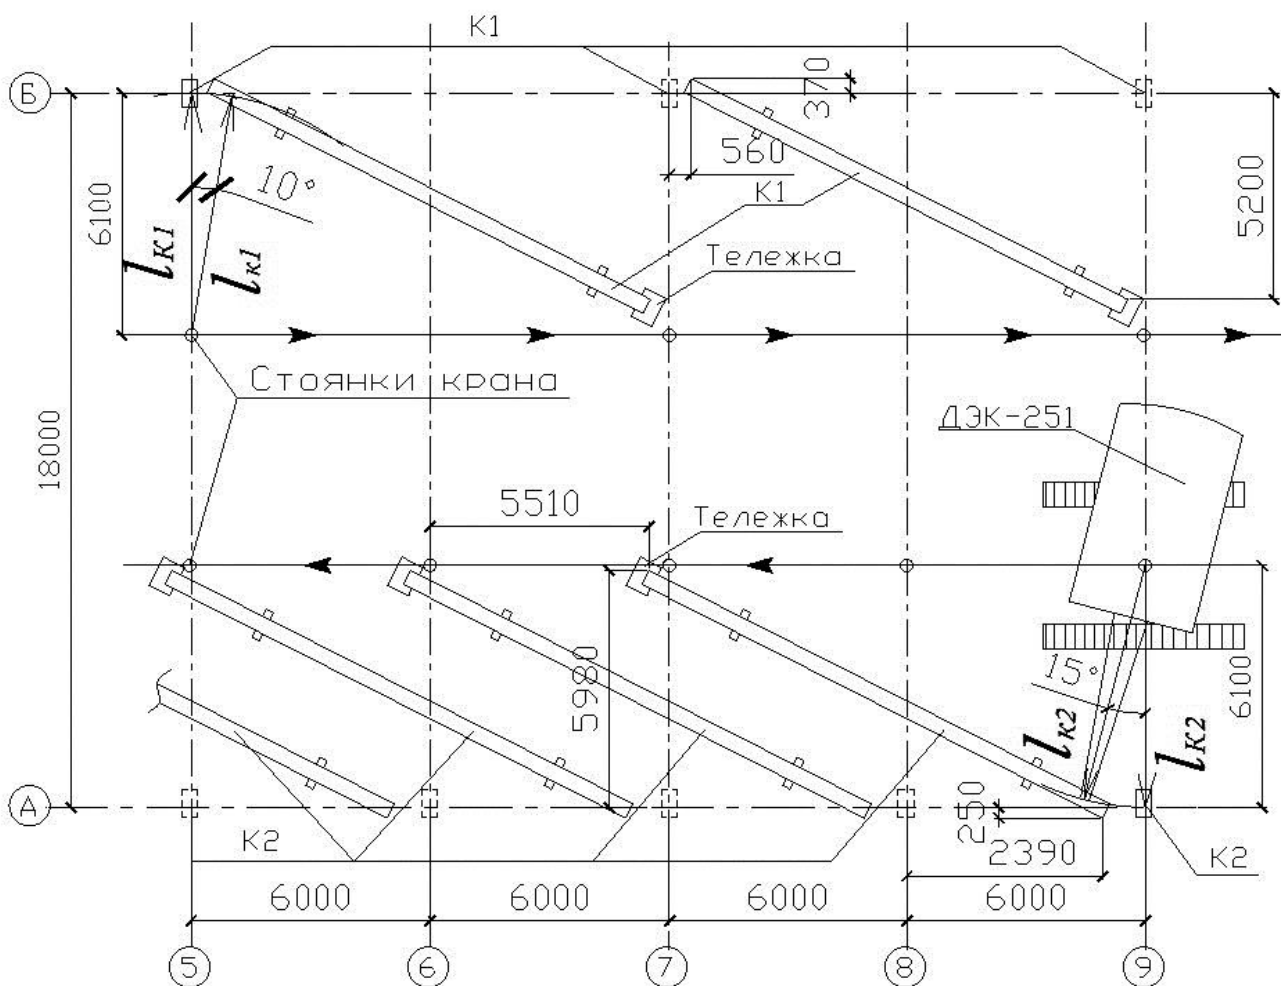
Схема монтажа колонн способом скольжения без изменения вылета стрелы и с перемещением крана вдоль ряда колонн
